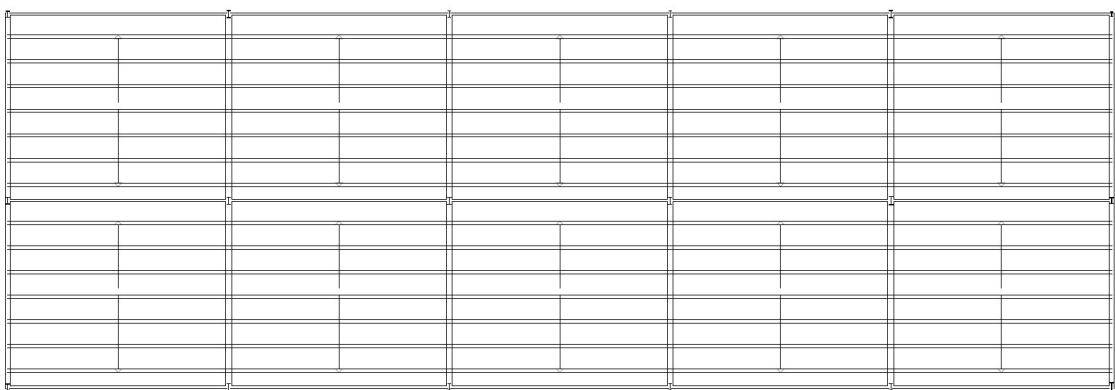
Esquema del forjado en cubierta de la zona de oficinas
